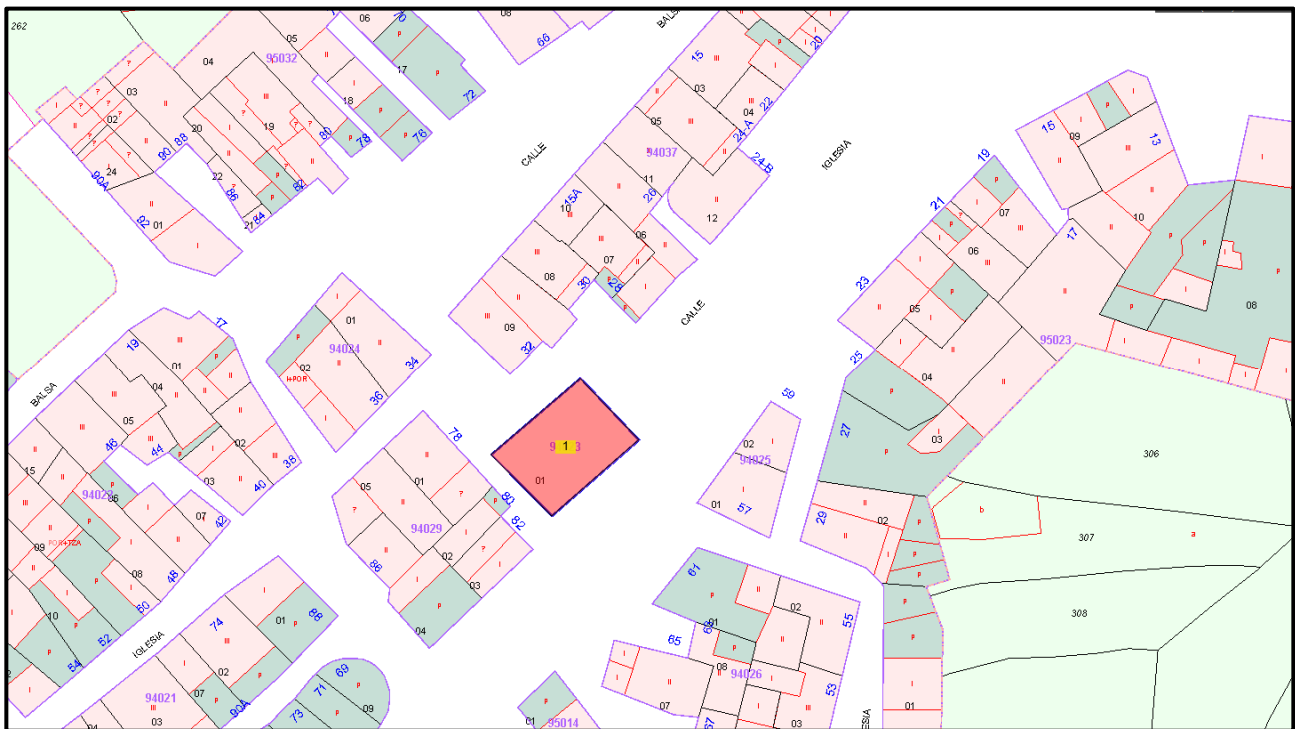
Plano de emplazamiento del Edificio denominado BAR MULTISERVICIOS.
